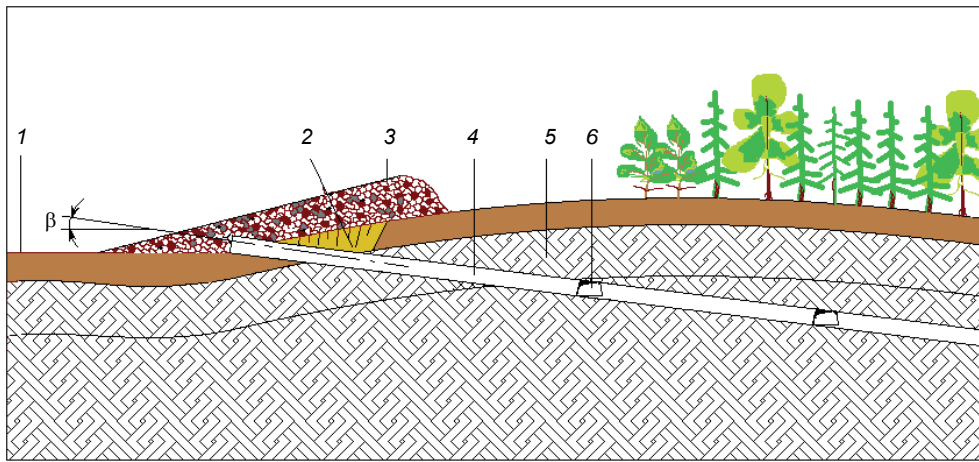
Схема вскрытия и подготовки угольного пласта (вертикальный разрез). 1 – рабочая площадка; 2 – наклонная разрезная траншея; 3 – внешний отвал; 4 – наклонная выработка; 5 – зона выветренных горных пород; 6 – горизонтальная слоевая камера / Figure 2. Scheme of dissection and preparation of coal seam (vertical cross-section).
